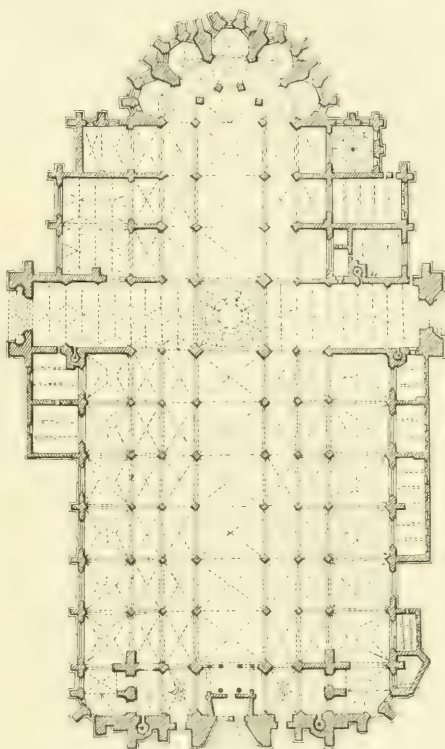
Kathedrale von Antwerpen. Grundriss.
